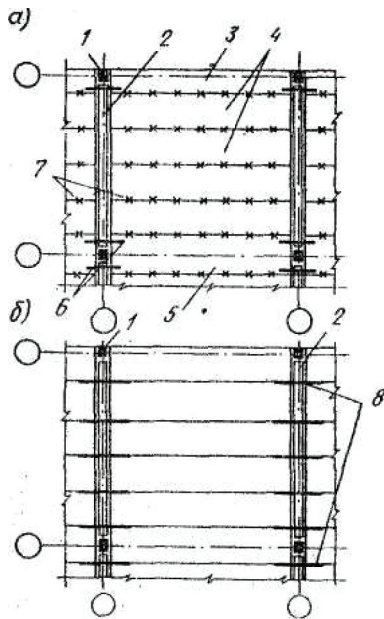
Сопряжения сборных железобетонных элементов для образования диска перекрытия:
